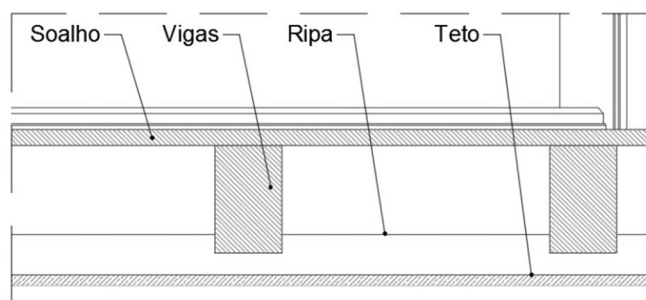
Pormenor do pavimento em madeira (s/escala) – (Autor)
